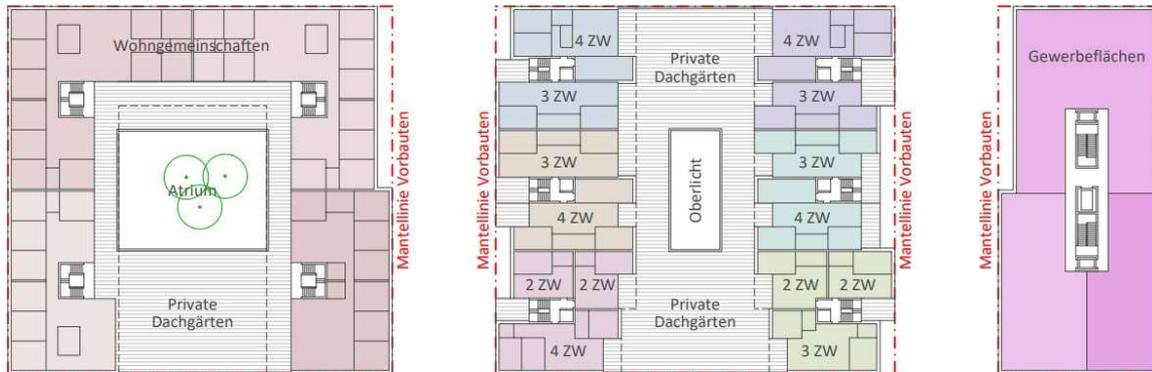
Schematische Grundrisse (Machbarkeitsstudie atelier ww, Zürich)
